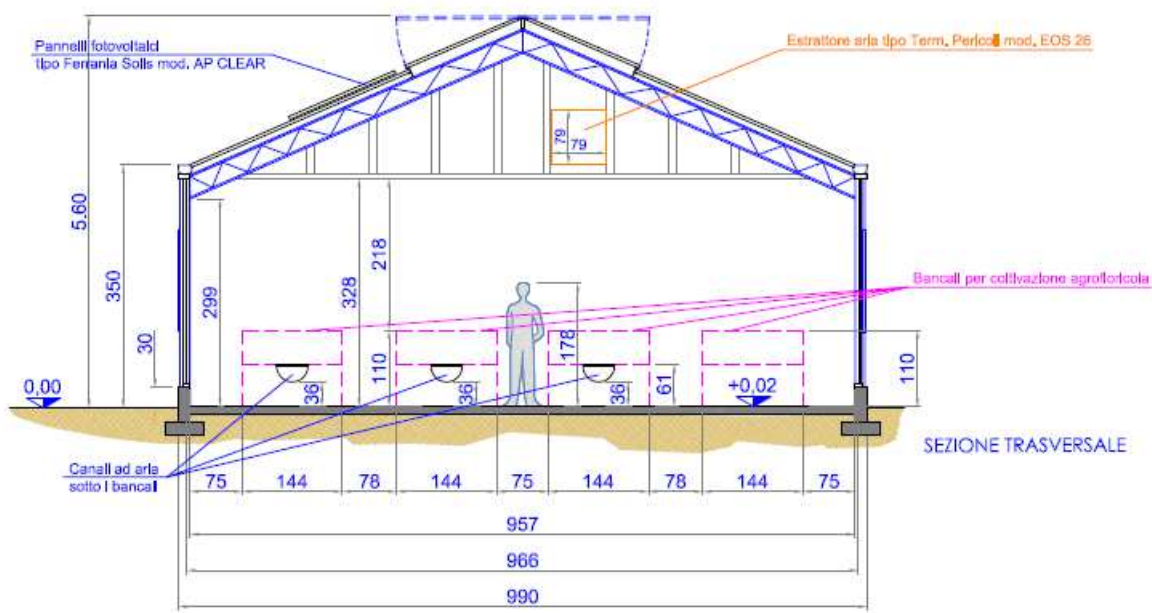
Tavola di progetto Sezione trasversale e posizionamento maniche
